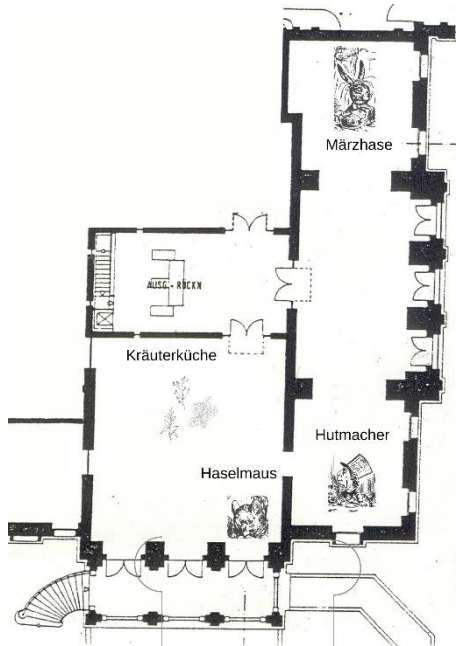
Lageplan mit eingezeichneten Stationen, erstellt mit Canva
